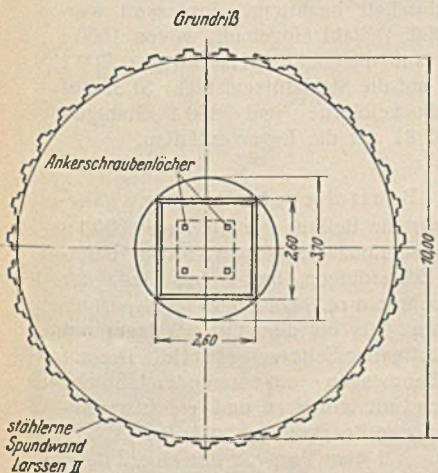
Grundriß des Grundkörpers für einen Stützenstiel.
